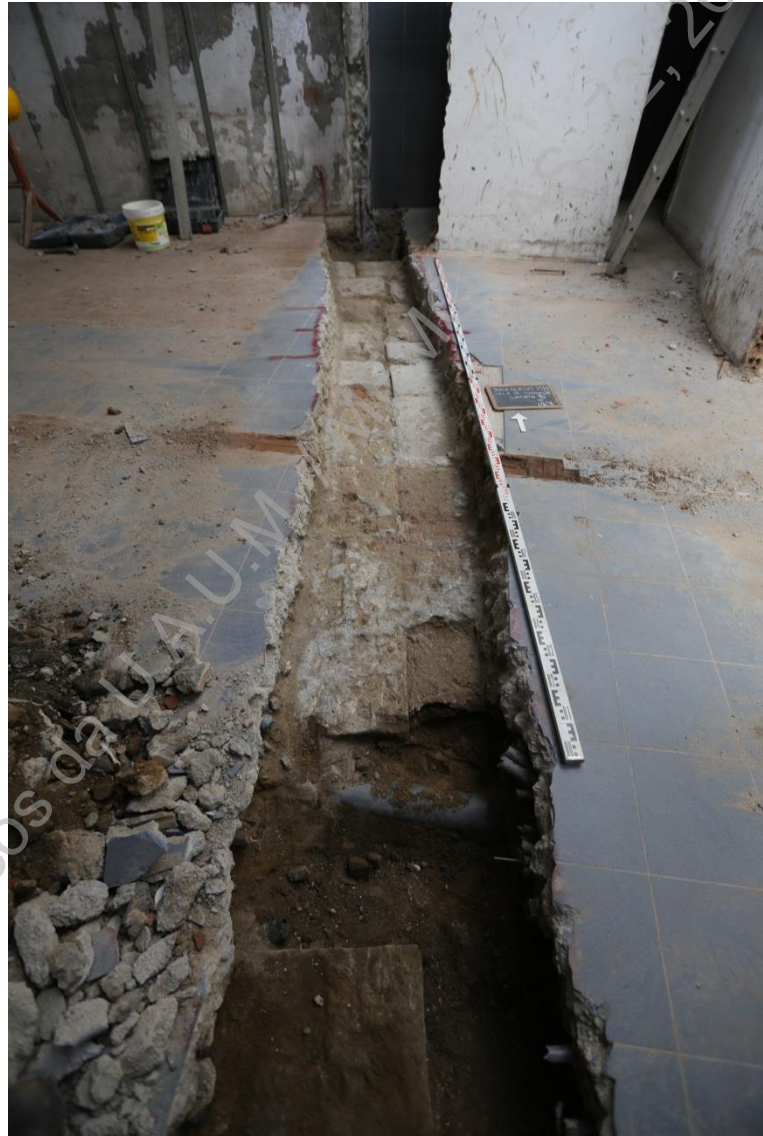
(IMG_1731) – Primeira fase de escavação da sapata 3 (S/N).
